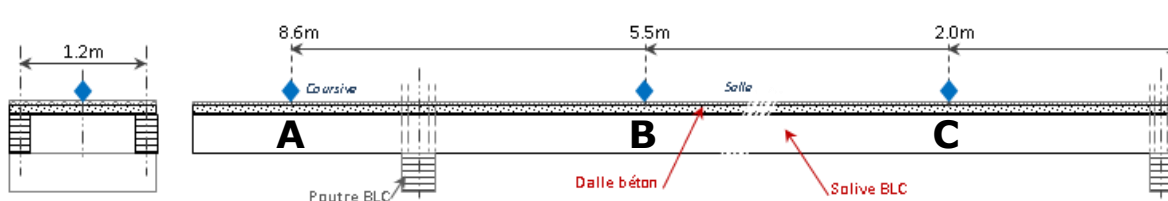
Position des accéléromètres le long d'une travée (vues en coupe)
